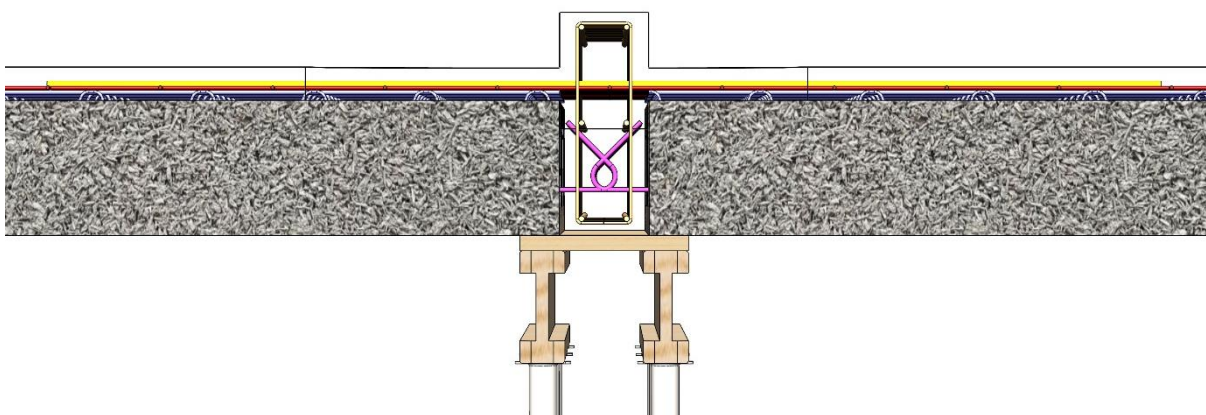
Prédalles suspendues sur bande noyée ou sur poutre voile sans retombée
